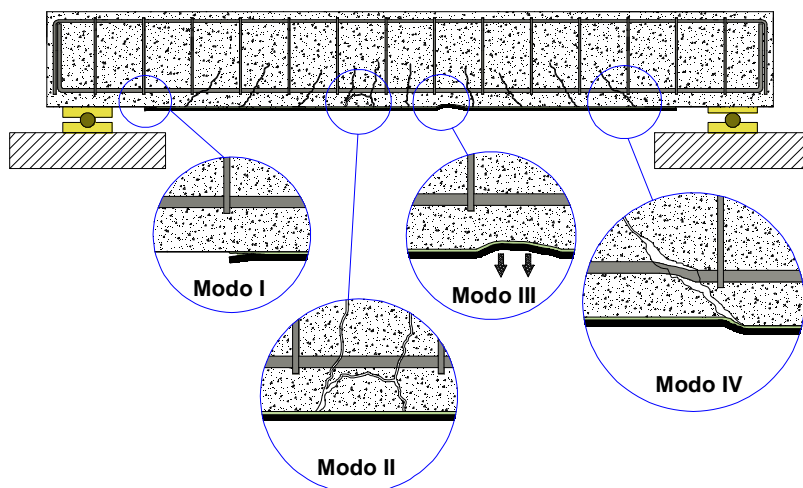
Roturas prematuras por peeling-off [adaptado de 20]
